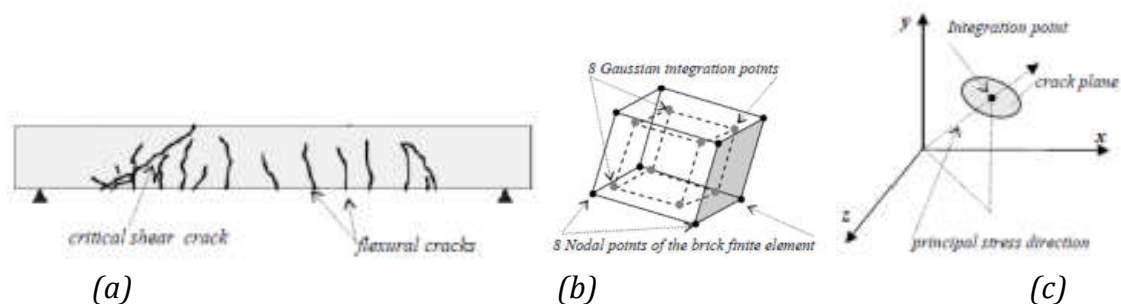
Développement des fissurations dans une poutre en béton :
